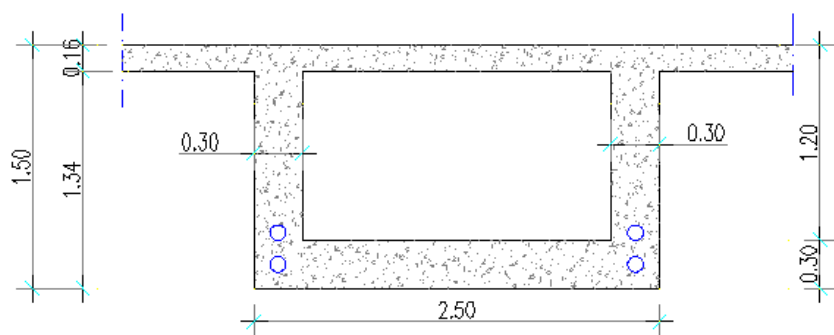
Secção transversal a meio vão da viga VPT.1.
